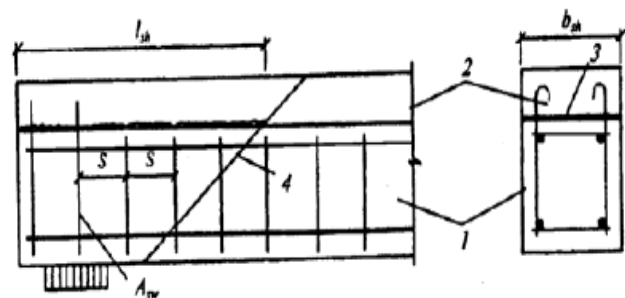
Схема для визначення зсувних зусиль, які сприймає поперечна арматура в контактному шві: 1 – підсилювана конструкція; 2 – бетон підсилення; 3 – контактний шов; 4 – похилий переріз
